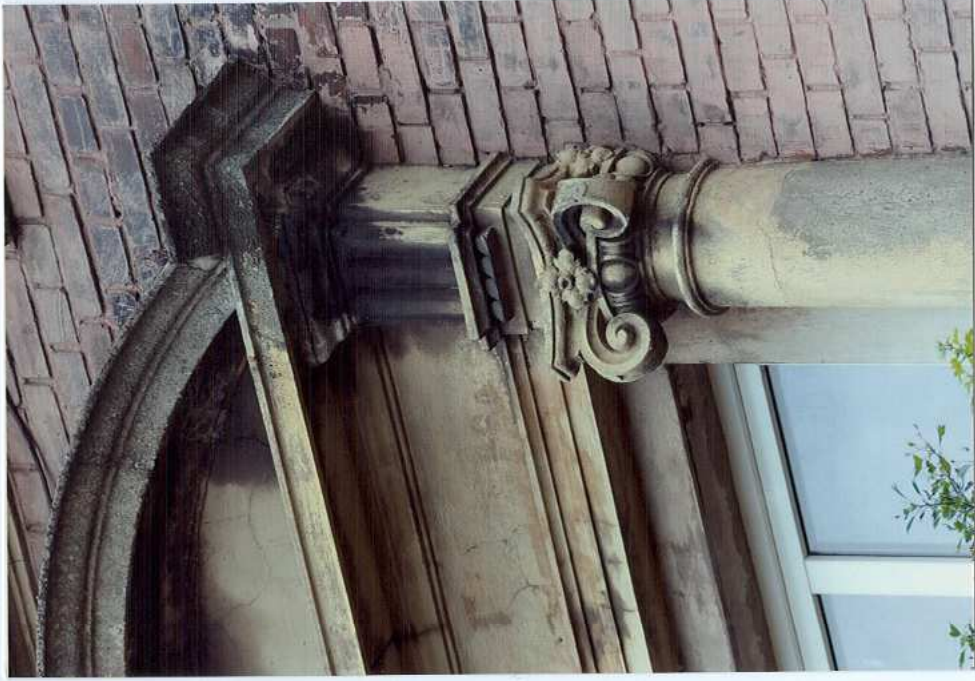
Pilaster – na wysokości gzymsu międzypiętrowego Fot. 8. Górna partia pilastra – elewacja północna.
